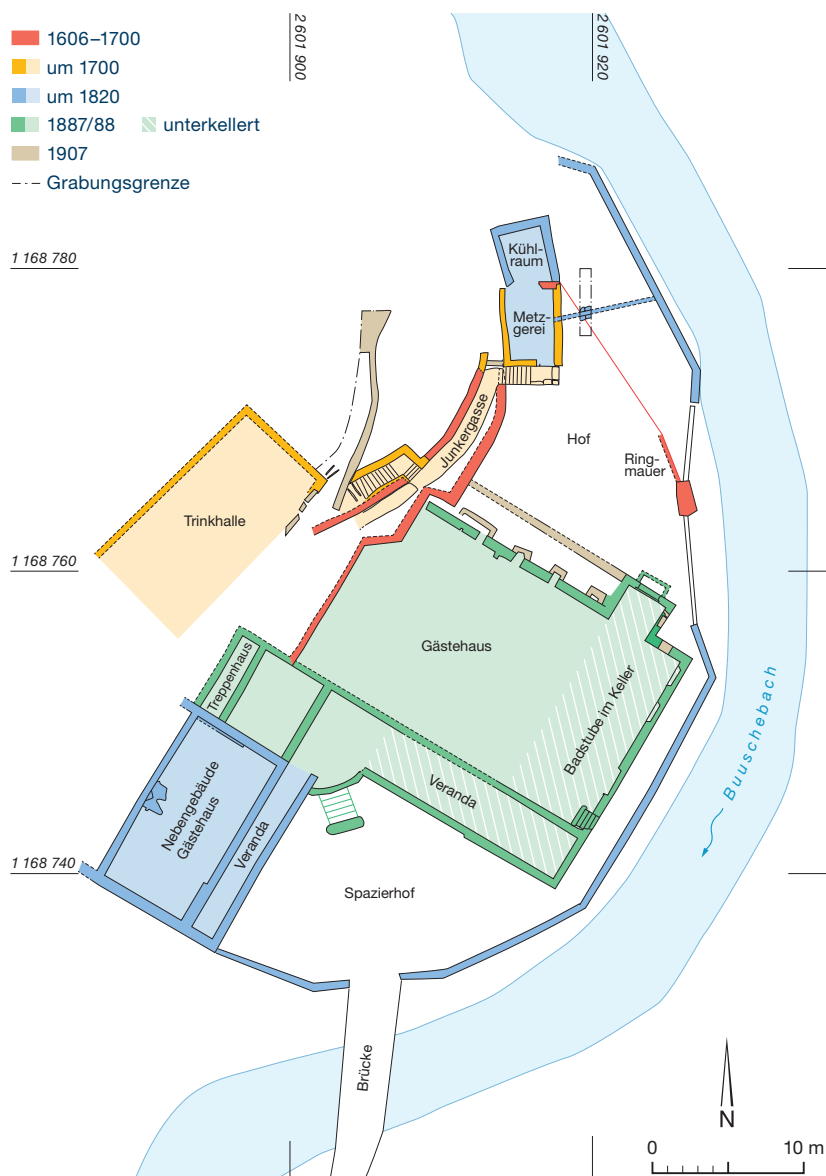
Oberwil i. S., Bad Weissenburg. Grundrissplan des Hinteren Bades mit den bei der Sanierung wiederhergestellten Gebäudegrundrissen des Hotelkomplexes aus der Zeit um 1900. Hervorgegangen ist dieser aus zwei getrennten Gebäuden, dem Badhaus (grün) und dem Gasthaus (blau). Wenige Mauern (rot) stammen aus der Frühzeit des Badebetriebs. M. 1:500.
